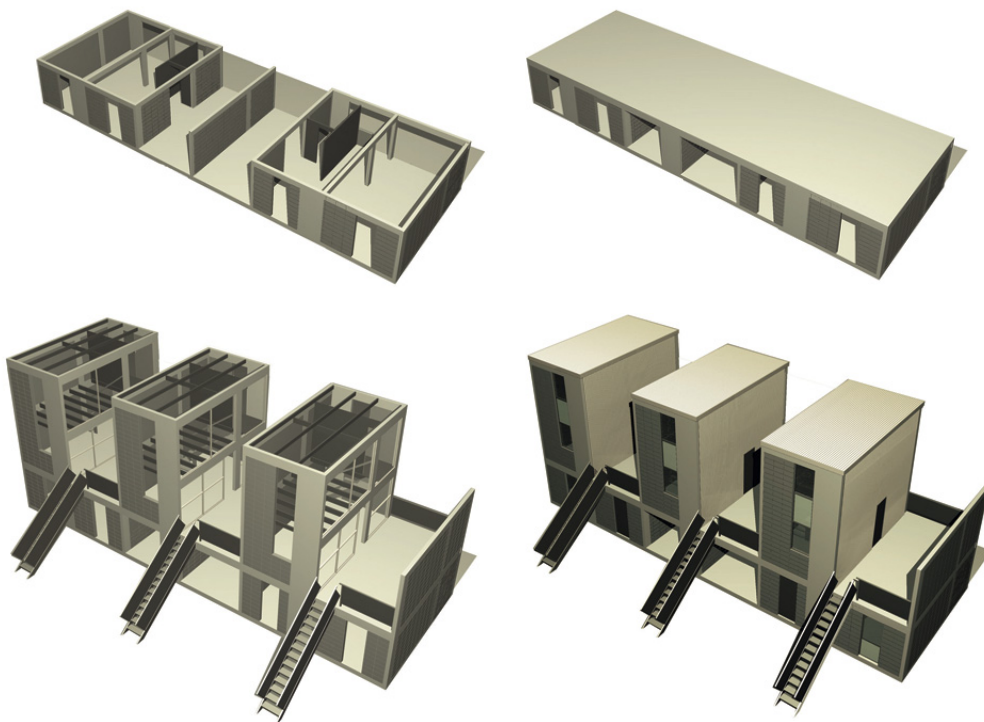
Projeto do conjunto em Iquique. Fonte: ArchDaily: Quinta Monroy / ELEMENTAL
